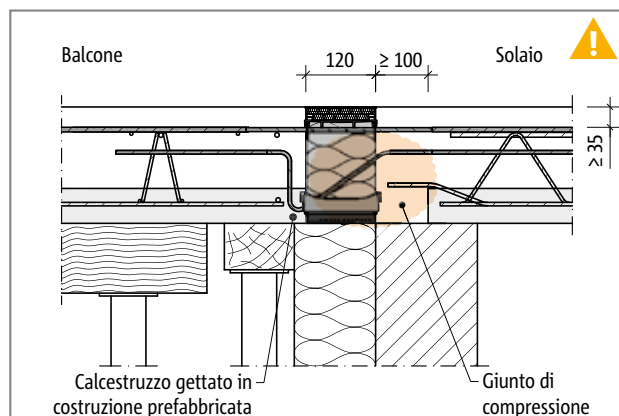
Schöck Isokorb® XT tipo KL-F: giunto di compressione lato solaio collegato a piastre prefabbricate; appoggio diretto
